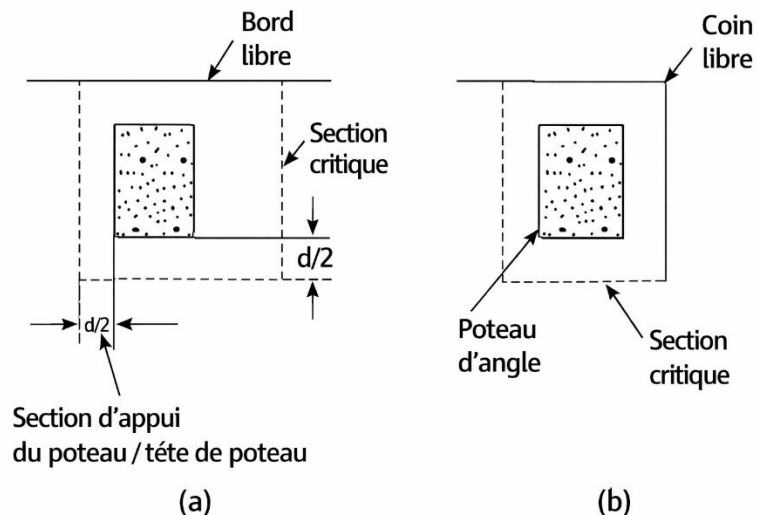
Section critique pour les poteaux près du bord libre d'une dalle [3]
